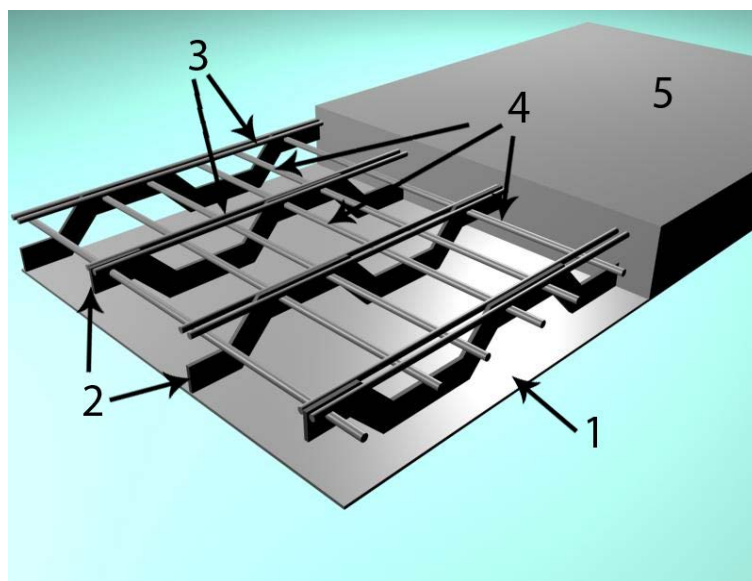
Общий вид сталебетонной конструкции с использованием упрочняющего элемента: 1 – стальной опорный лист; 2 – фасонная арматура (упрочняющий элемент); 3 – продольная стержневая арматура; 4 – поперечная стержневая арматура; 5 – бетон
